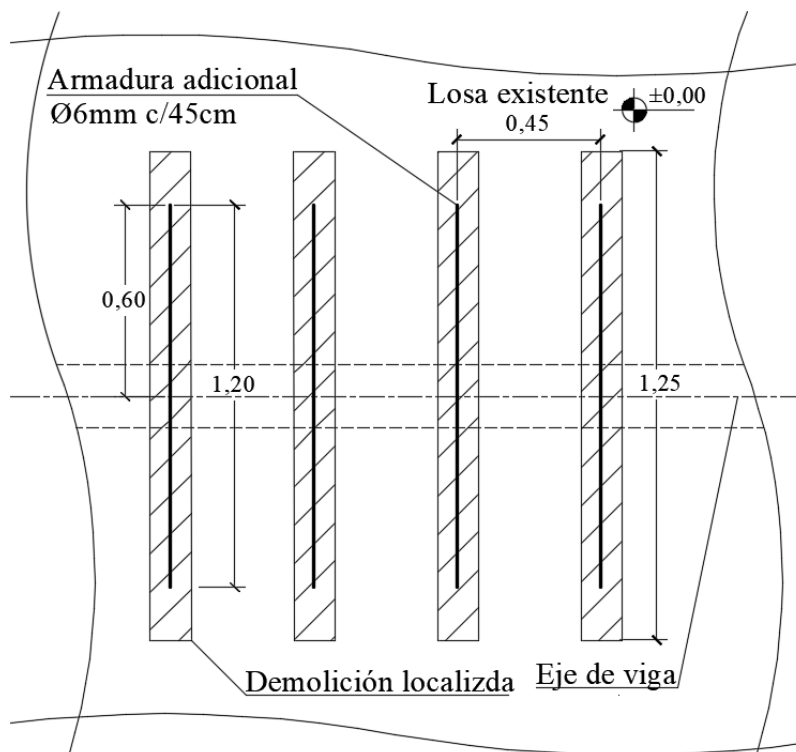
Armadura adicional Apoyo Losas L2/L3, L2/L9 y L6/L9.
